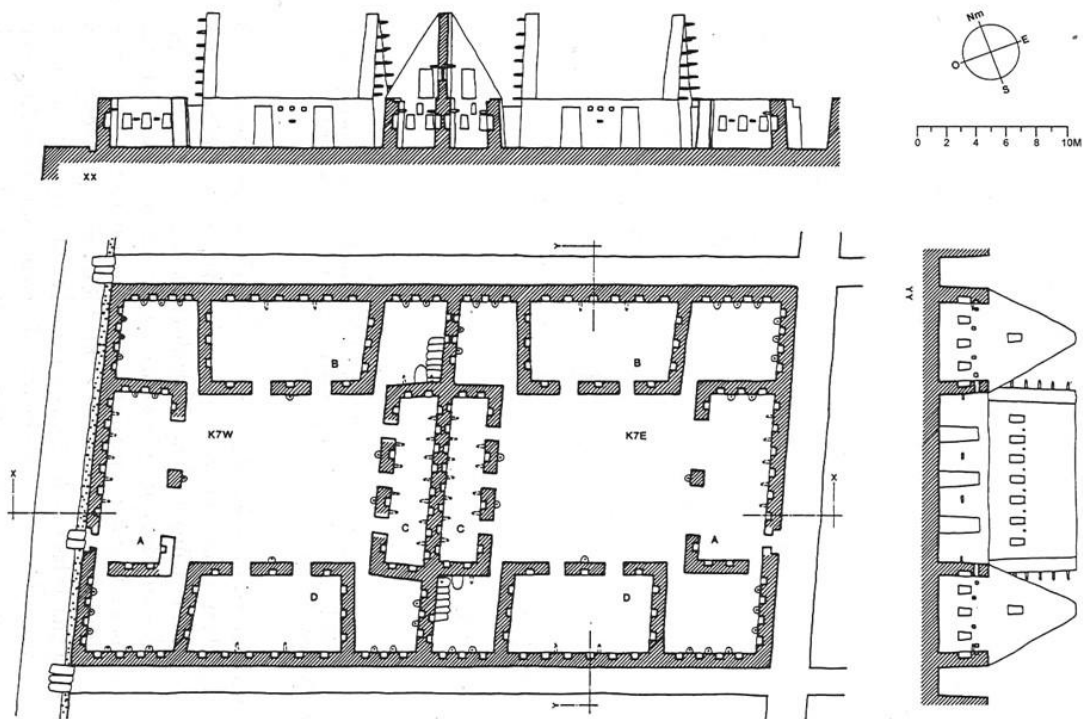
Manzanera 7 de Ollantaytambo. Levantamientos de planta y secciones efectuadas por Jean-Pierre Protzen.
